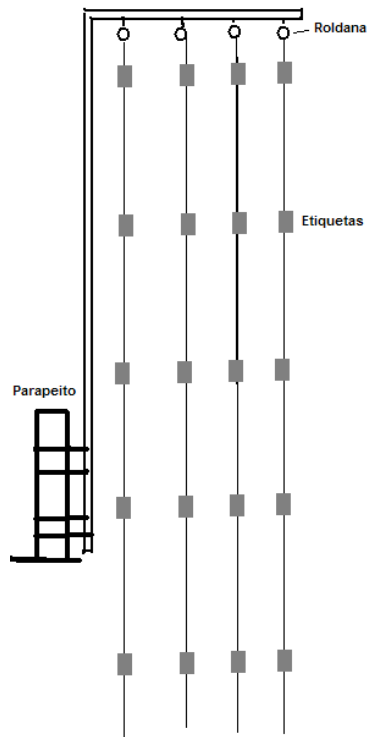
Estrutura metálica para adaptação ao viaduto.
